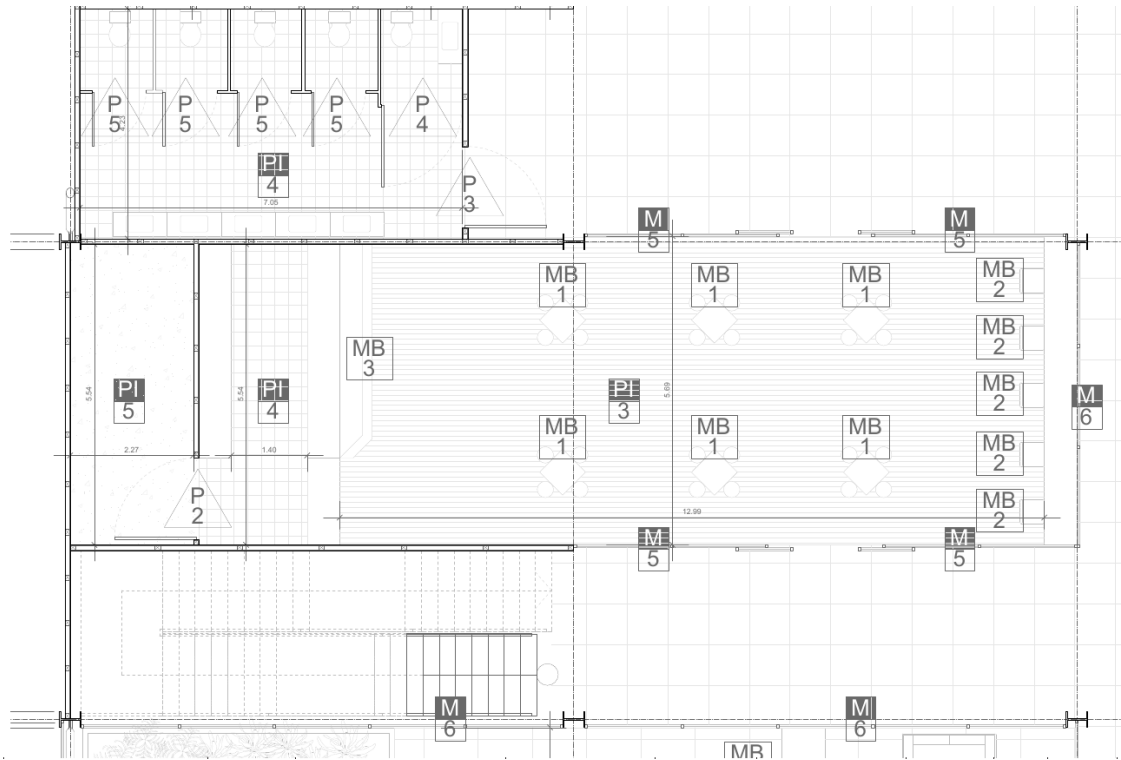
Planta constructiva cafetería bloque financiero, Fuente: Elaboración propia
